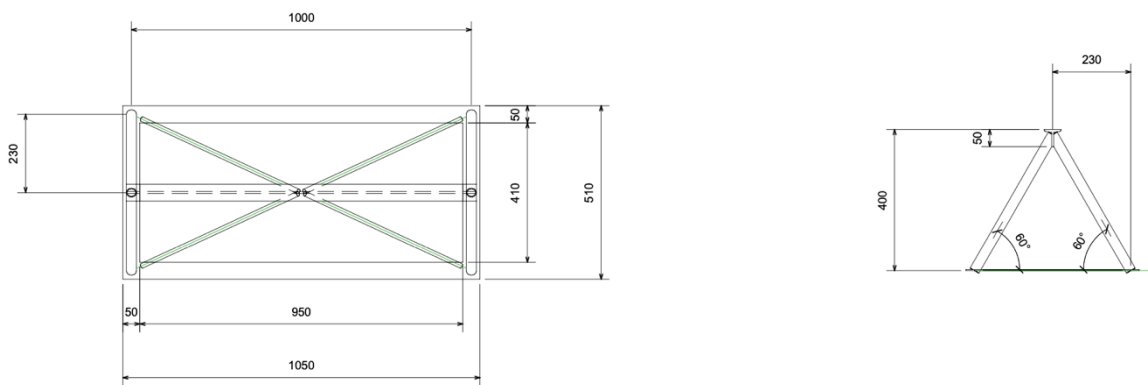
Plan et coupe des supports de la passerelle amont
